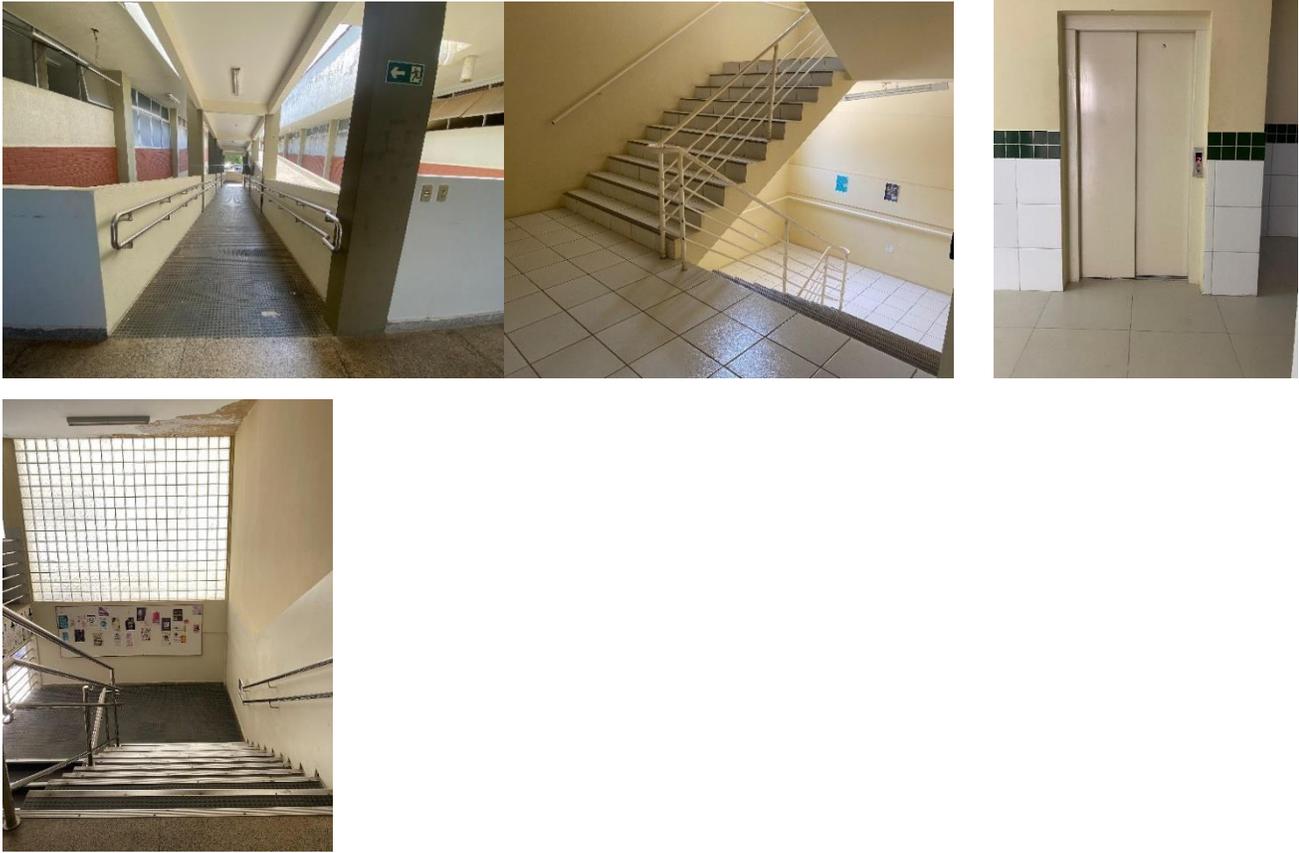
a, 03 b, 03 c e 03 d – Acesso Salas de aula através de rampas e escadas com piso antiderrapante e corrimão e Elevador
